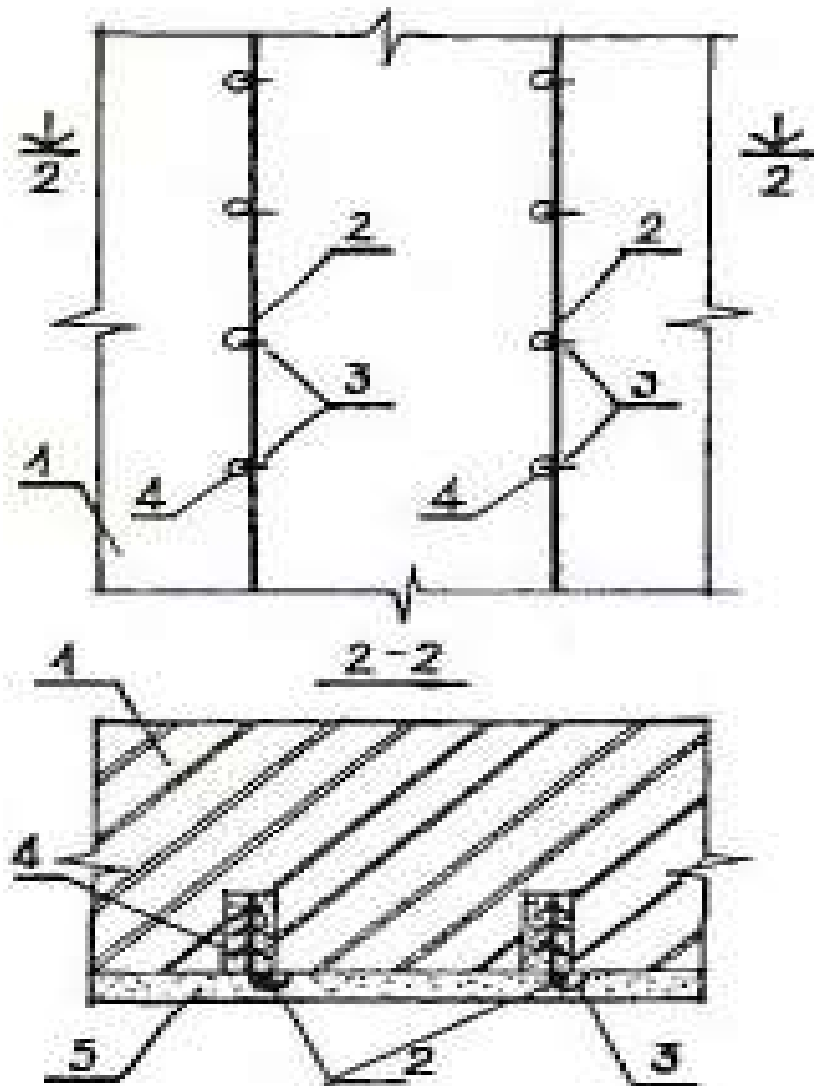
Посилення цегляних конструкцій односторонньою залізобетонною обіймою: 1 – стіна, яка підсилюється; 2 - поздовжня арматура; 3 – анкери ; 4 - отвори для анкерів; 5 – штукатурка
